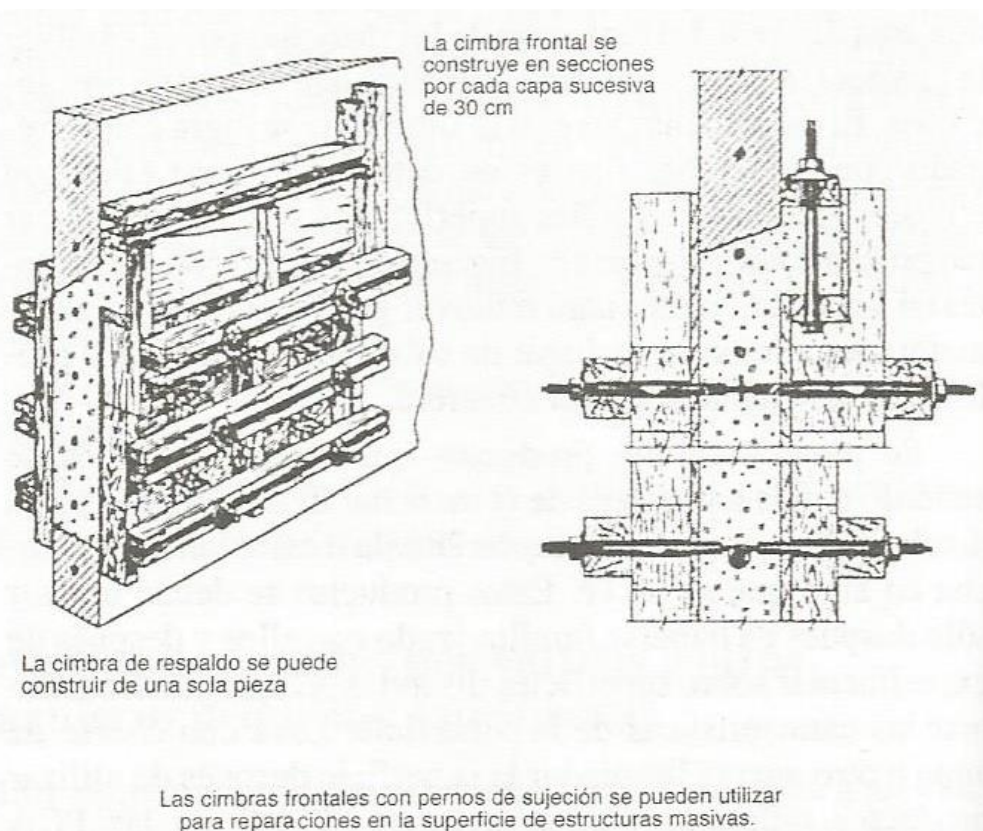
Cimbras para reparación de concreto en muros y parches grandes
